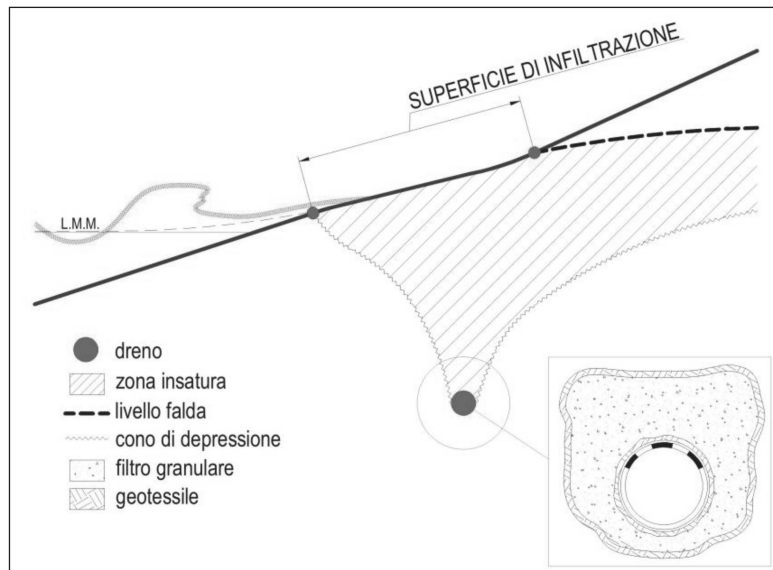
Azione del BMS sulla piezometria e particolare della sezione del drenaggio.
